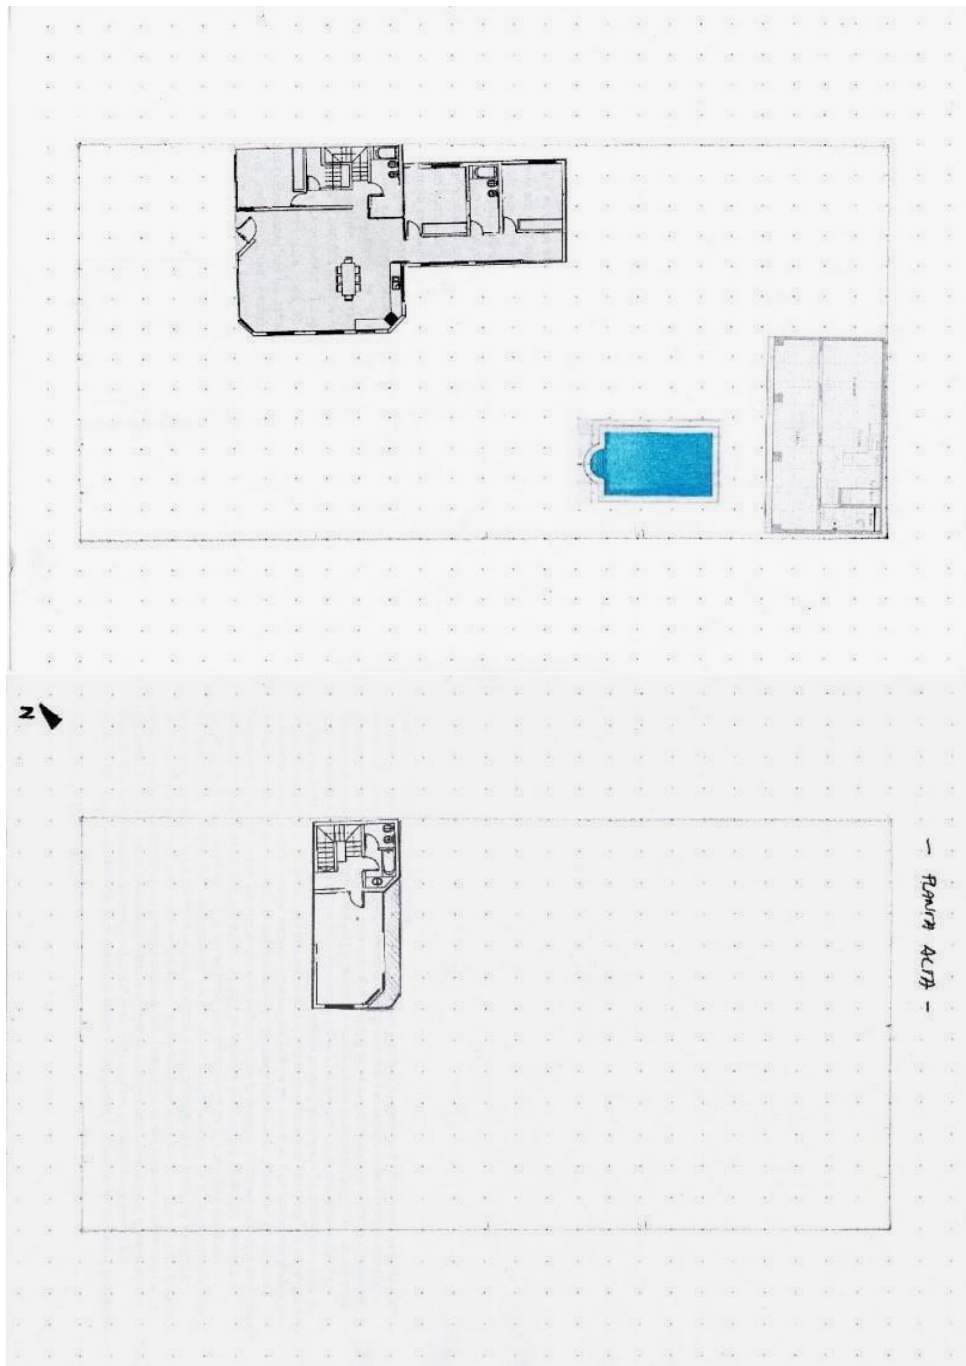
Ejemplo de planos de construcción planta baja y planta alta –
